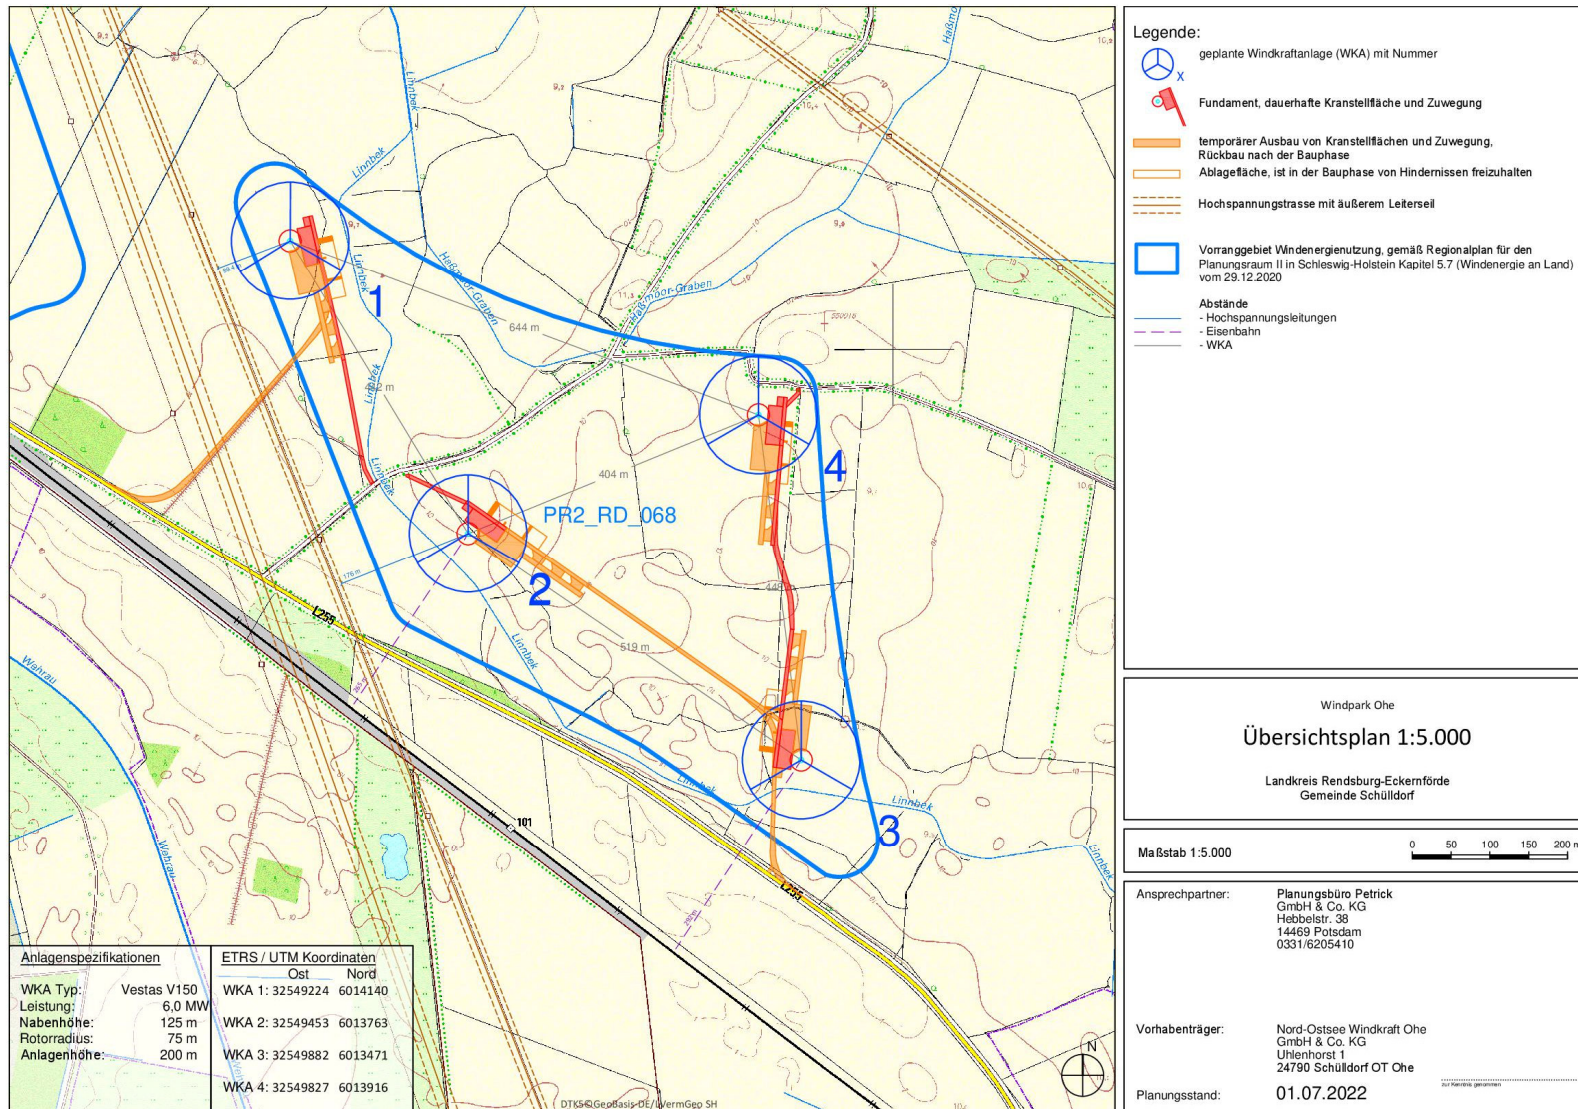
WEA-Standorte im Windpark Ohe innerhalb des Vorranggebietes PR2_RDE_068 (gem. PLANUNGSBÜRO PETRICK; Stand: 01.07.2022)
